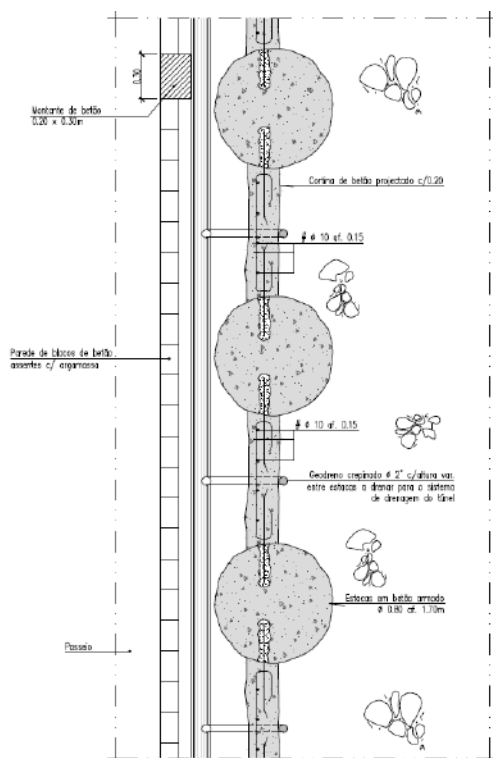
Muro M3 - Corte horizontal pela cortina.
